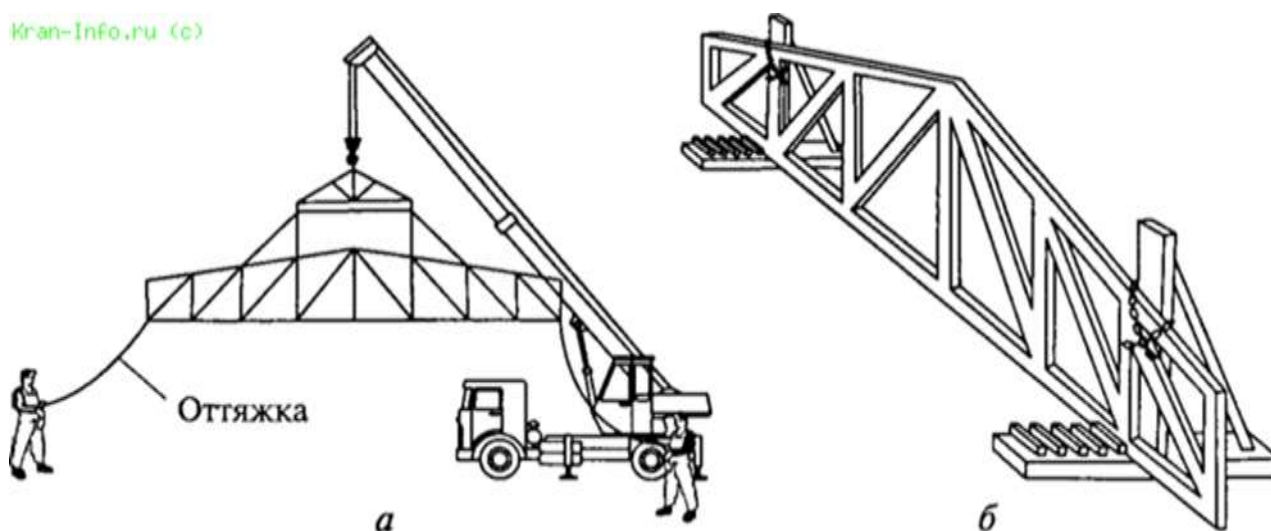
Строповка (а) и складирование ферм на металлических опорах (б)
